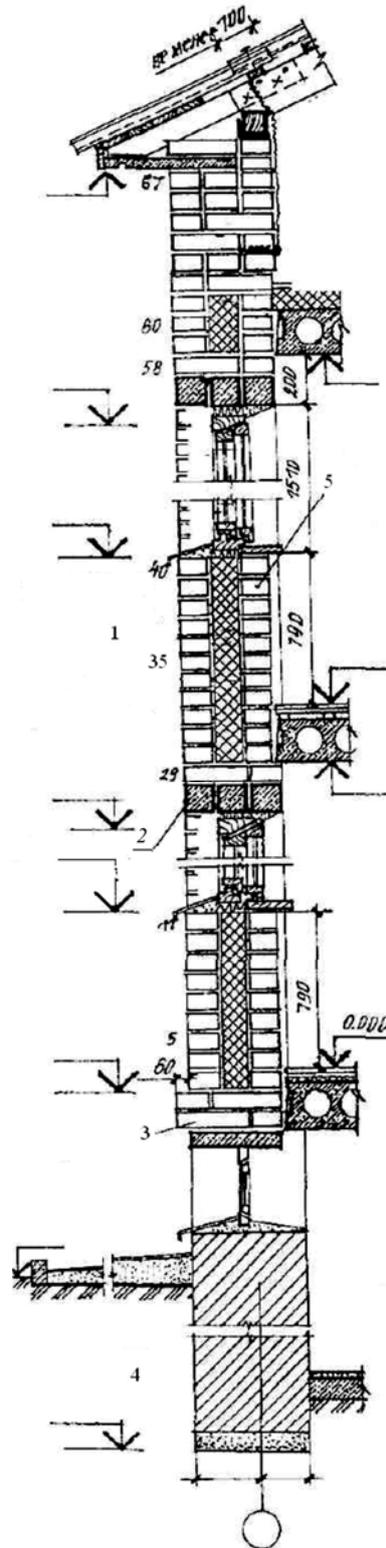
Порядовка наружной стены: 1 — эффективная кладка стены с вертикальными поперечными стенами воздушной прослойкой; 2 — брусковые перемычки; 3 — поясная тяга из кирпича; 4 — стены подвала из бутобетона; 5 — модульный кирпич
